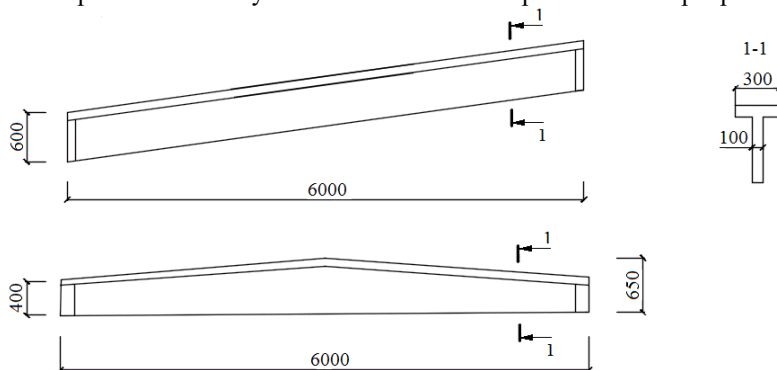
Конструктивная схема балки скатных покрытий пролетом 6 м
